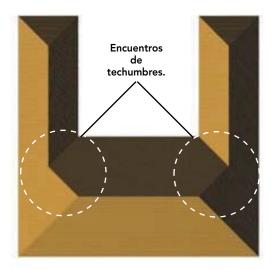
Vista en planta de una techumbre, donde se aprecian dos encuentros de techumbres.
